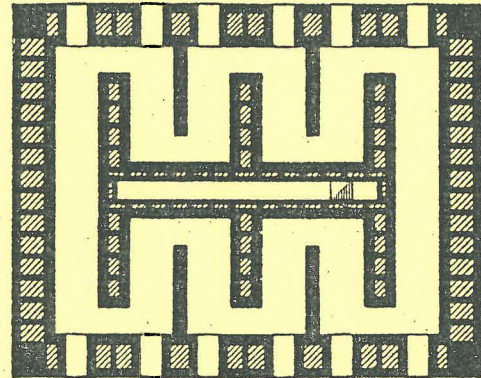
Zickzack-Ringofen mit 12 Kammern. Grundriß.
